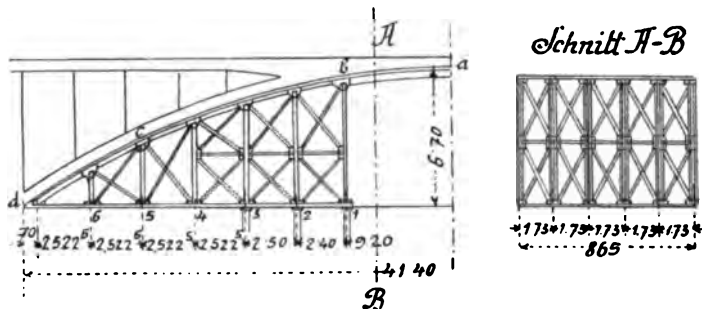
Lehrgerüst der Mittelöffnung des Viaduktes zu Deurne-Merxem.
